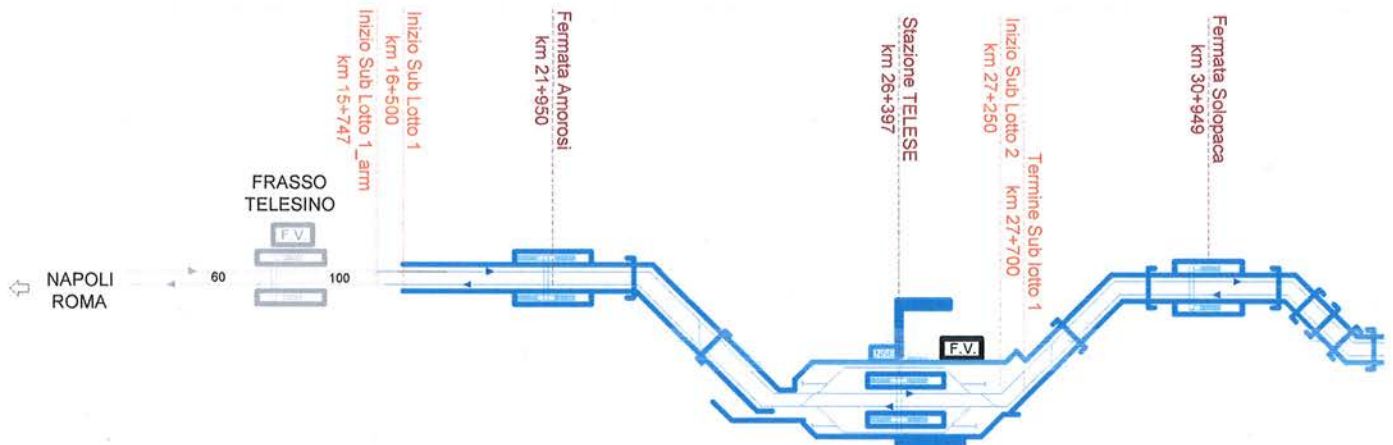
Schematico della Situazione finale di progetto – Sub Lotto 1 e sub Lotto 2
